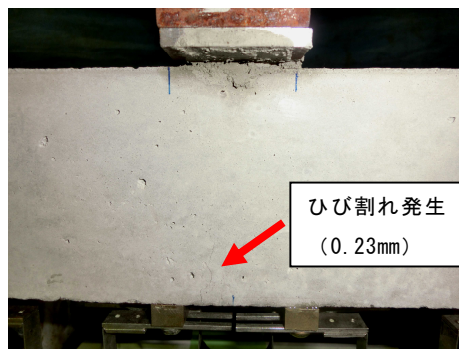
EP01 ひび割れ発生時 (側面)
